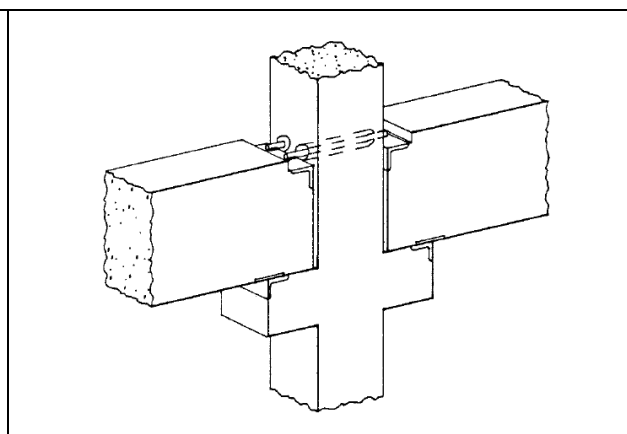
Ligação por consola curta de betão e chapas aparafusadas (Sidney, 2000)
